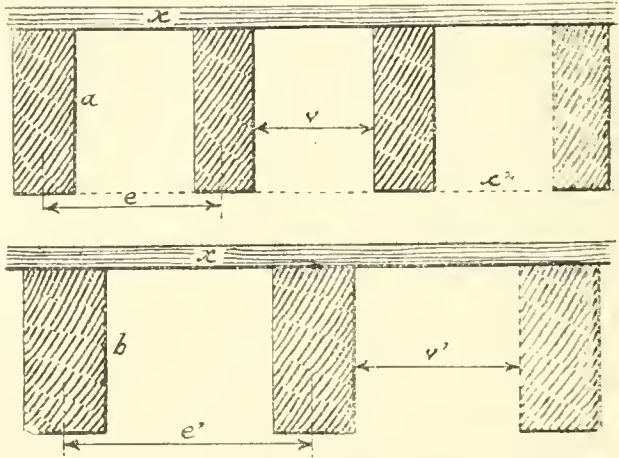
Coupe en travers de planchers à solives rectangulaires.
